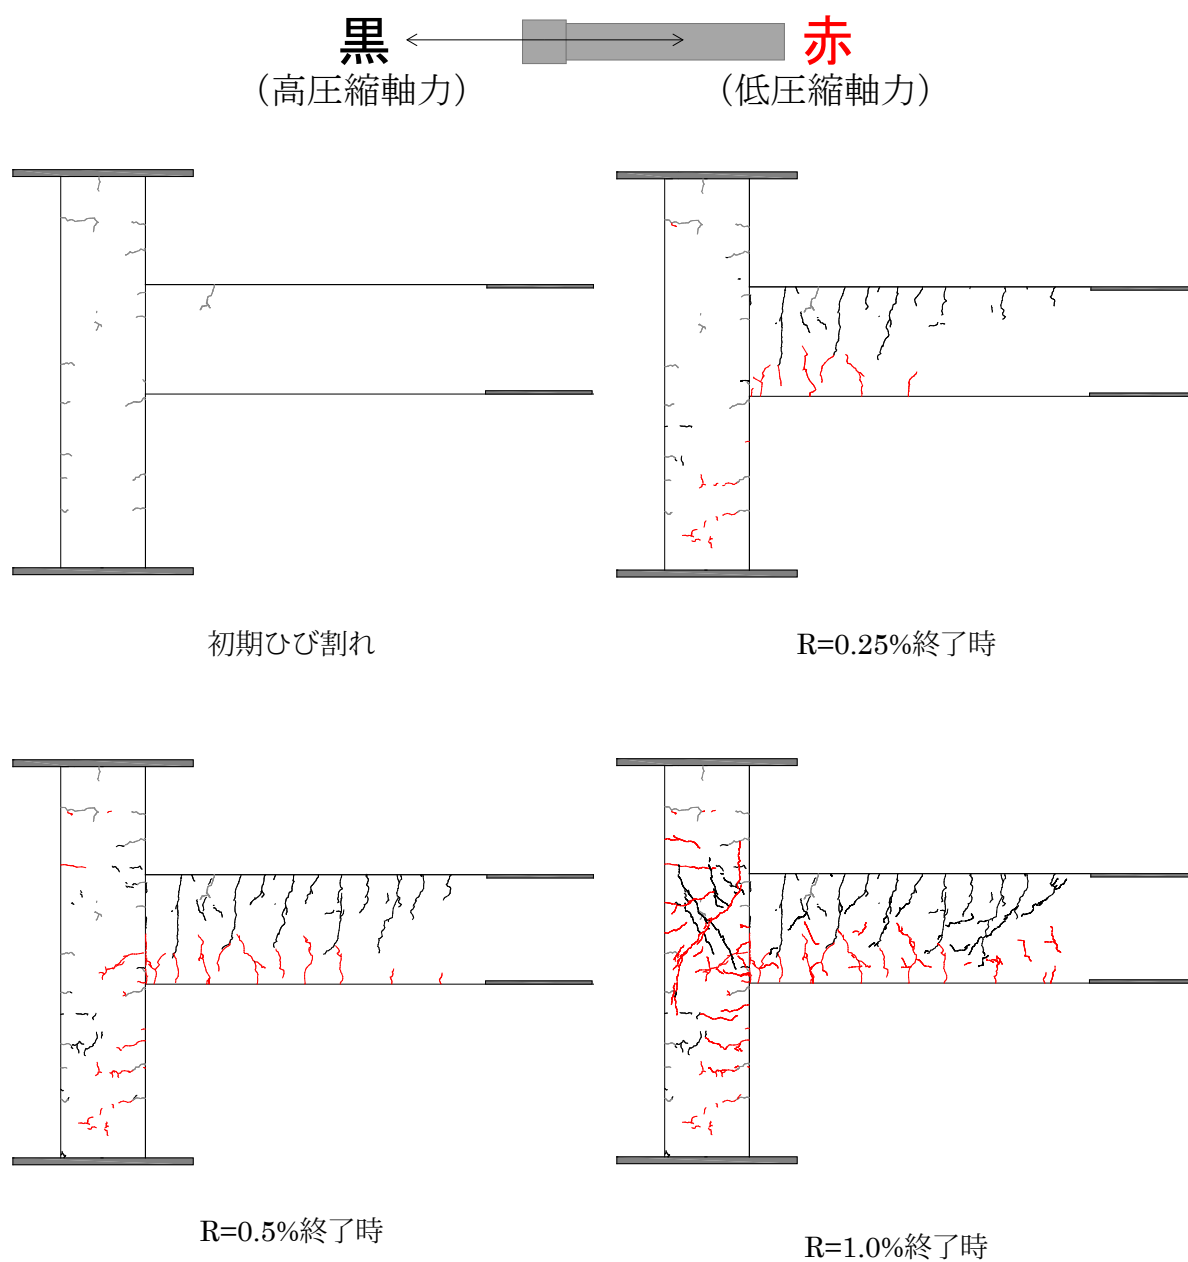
(a) ひび割れ状況 (試験体 F1)
